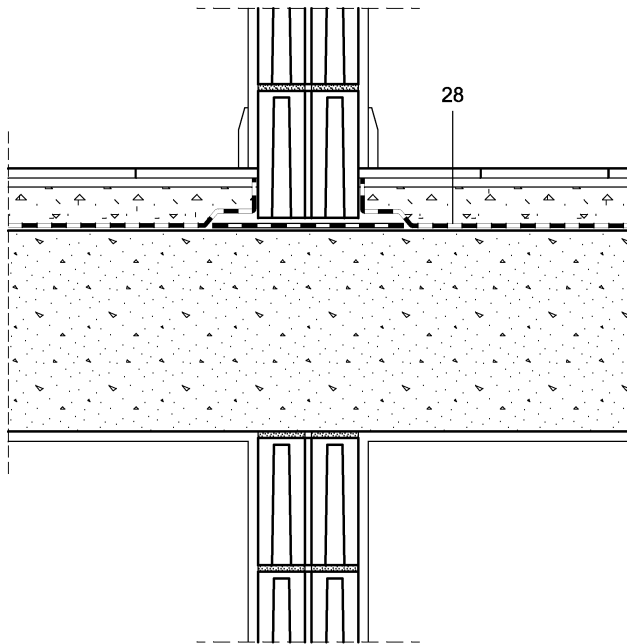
Arranque de muro no portante interior sobre forjado con lámina antiimpacto.
